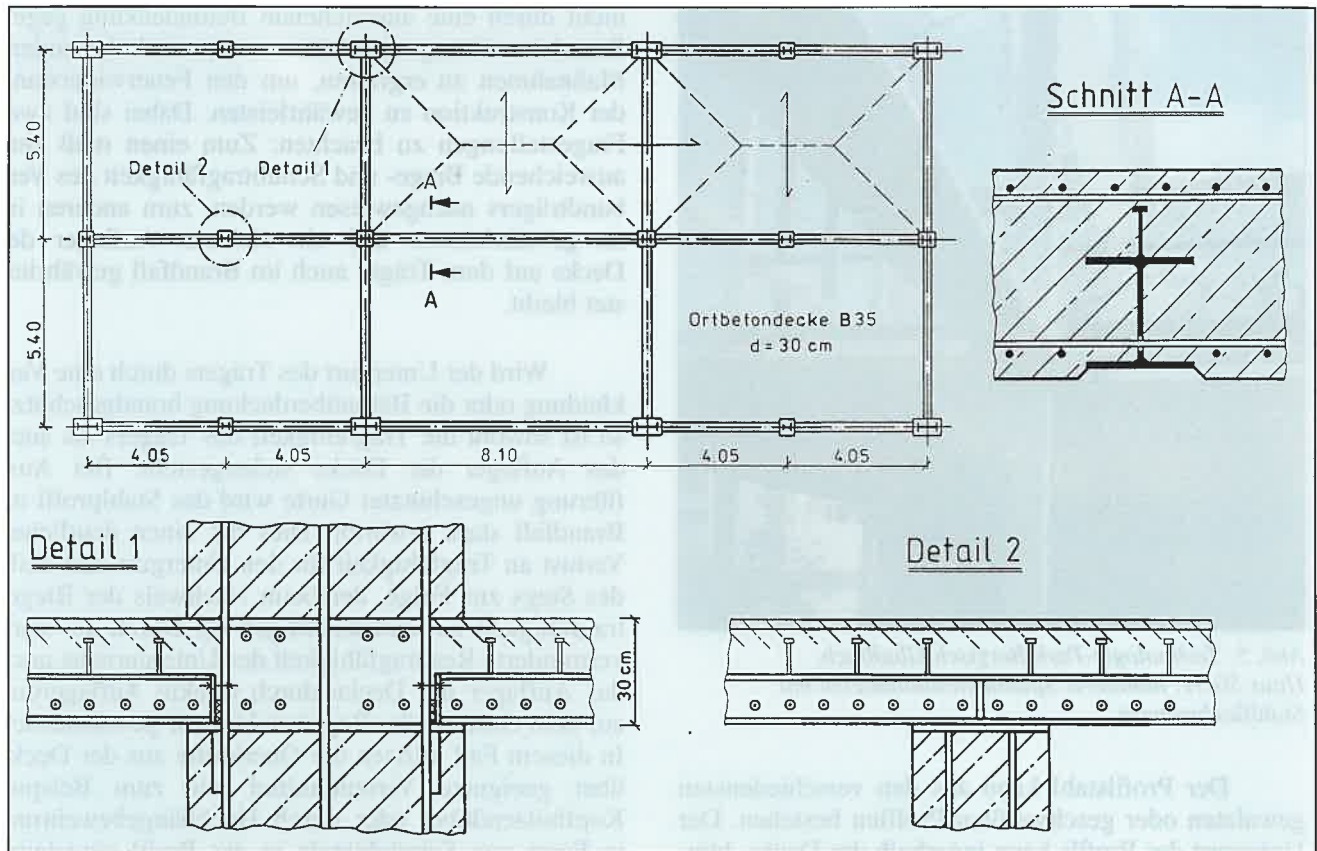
Goethe-Galerie Jena (Gesamtplanung: IFB Dr. Braschel GmbH, Stuttgart): statisches System der Flachdecke, Querschnitt und Anschluß an Stütze
